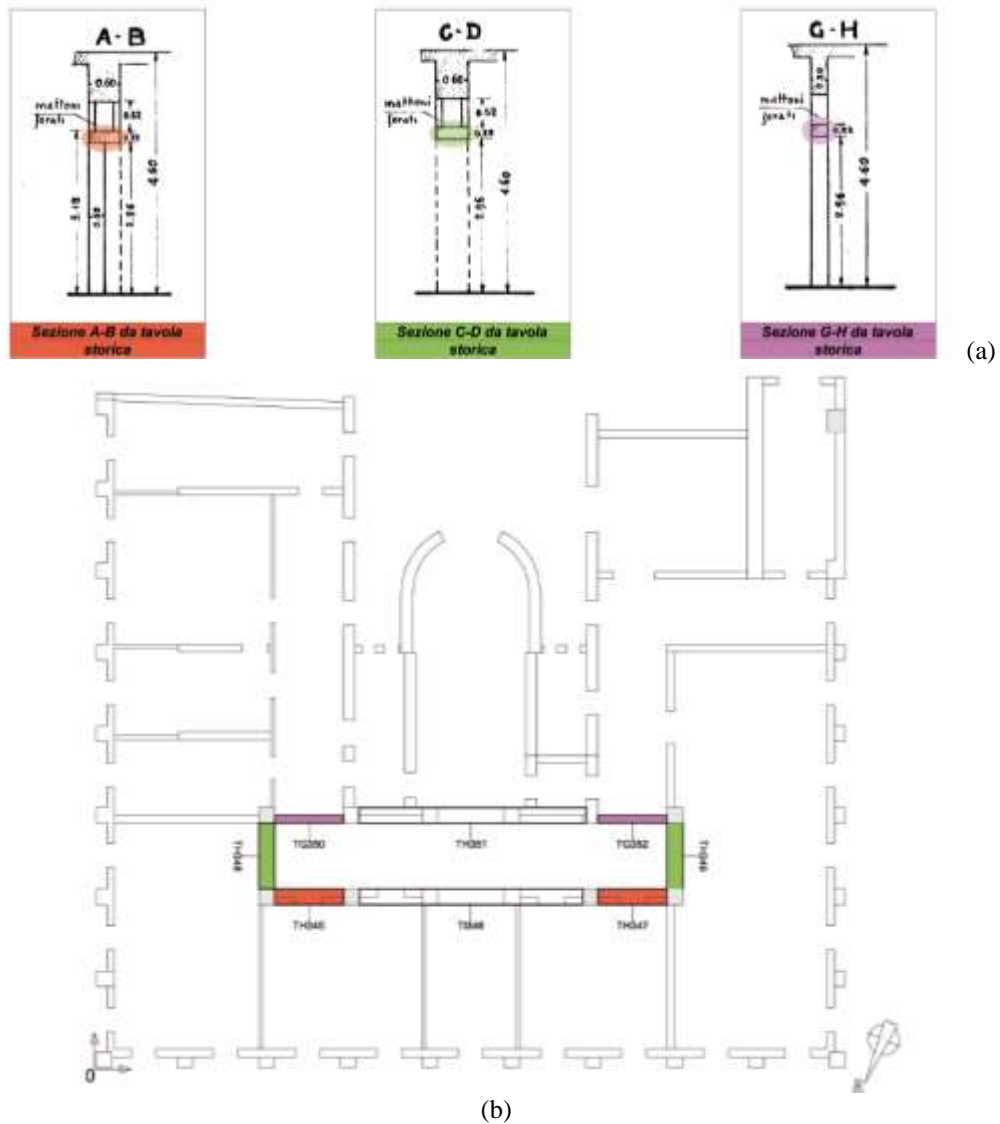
(a) Elementi orizzontali in c.a. posti a lato del corridoio principale al piano terzo (da progetto preliminare); (b) pianta con indicazione della nomenclatura adottata per gli elementi orizzontali in c.a. lato corridoio al piano terzo.
